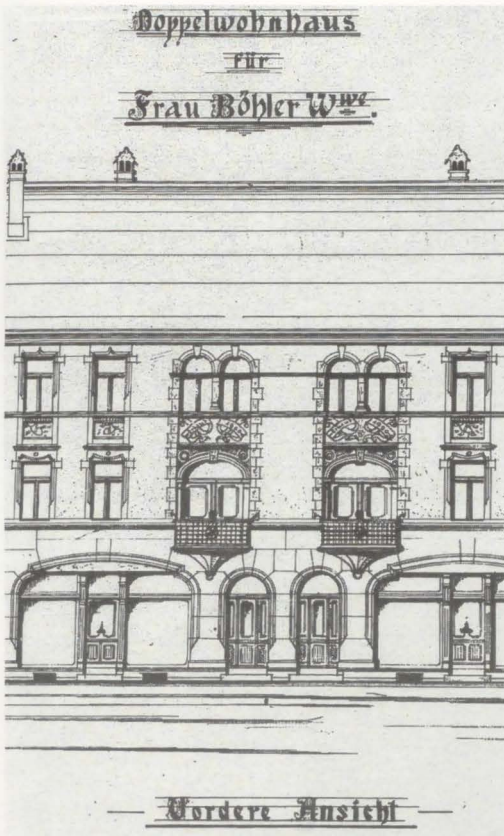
Bauplan Tumringer Str. 210/212, Stadtarchiv Lörrach (Foto: U. Falconer)
